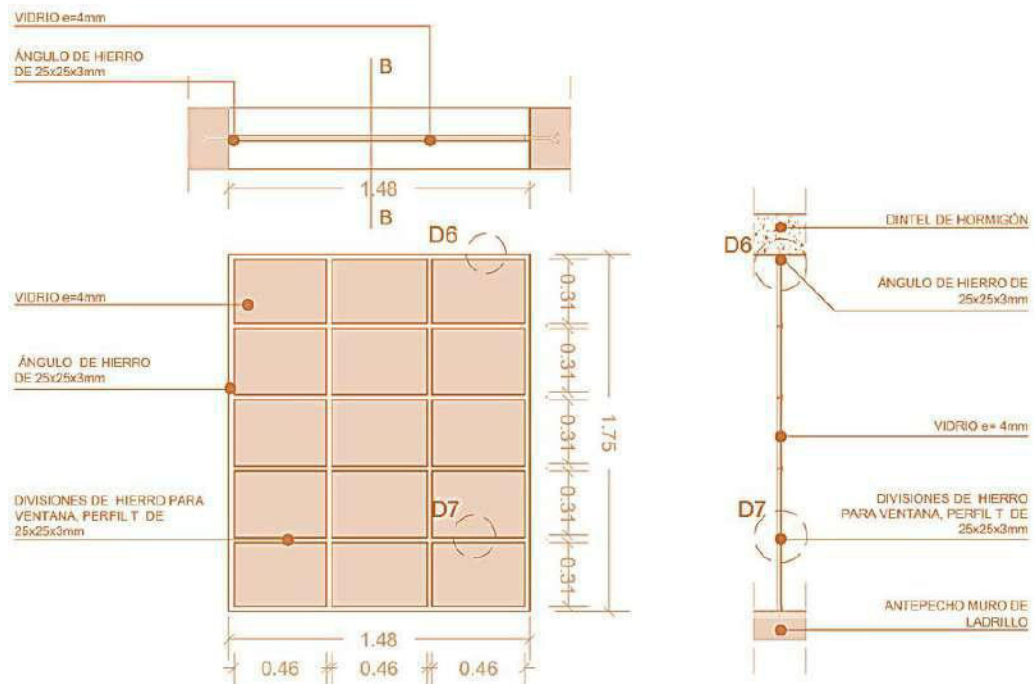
Detalles Constructivos. Fuente: Astudillo S. (2017).
